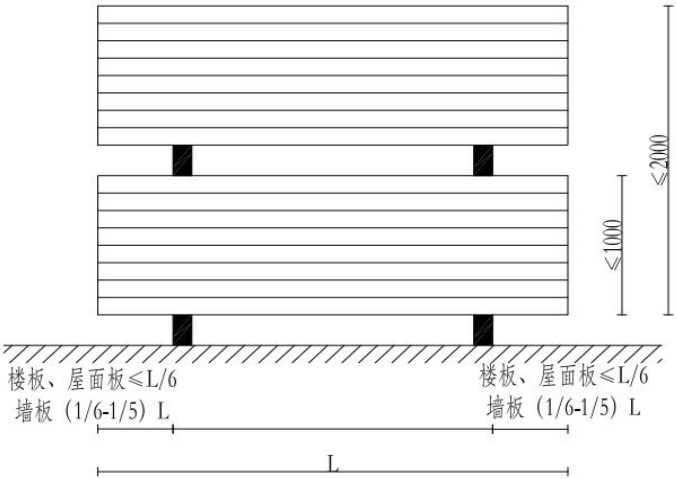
蒸压轻质加气混凝土板材堆放要求图
